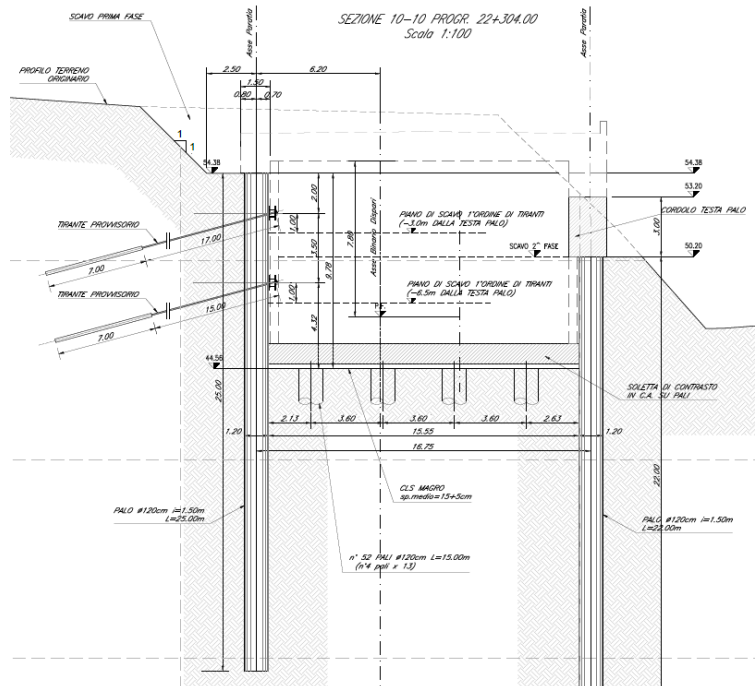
Sezione trasversale di scavo sezione tipo F, configurazione a doppia paratia
